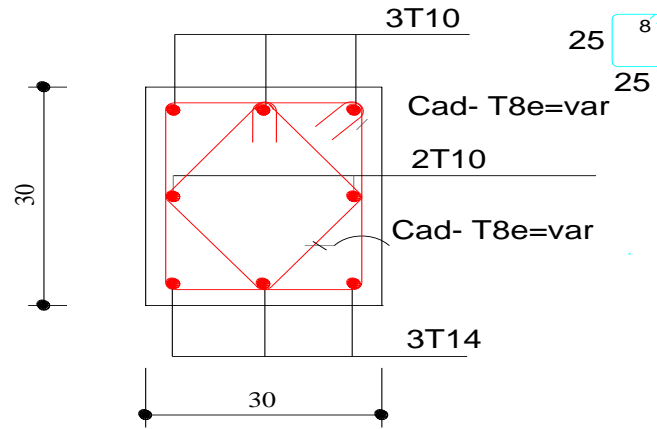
Ferrailage de la poutre palière (escalier commerciale gauche)
